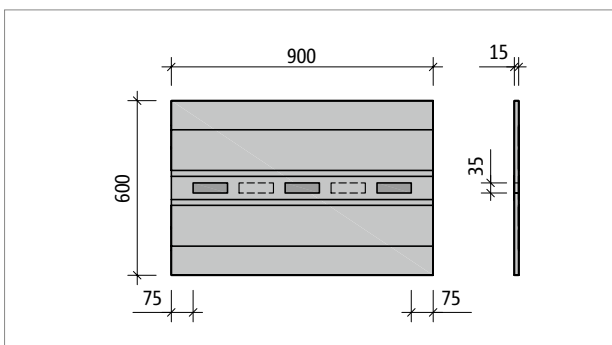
Schöck Tronsole® Typ B-V1...-B600: Produktgrundriss
